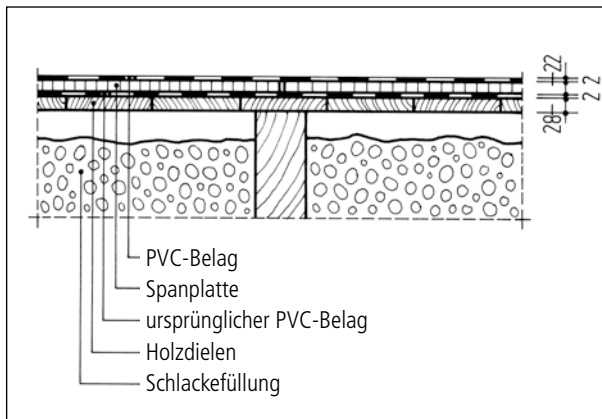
■ Vorgefundener Fußbodenaufbau mit Holzspanplatten und PVC-Belag
